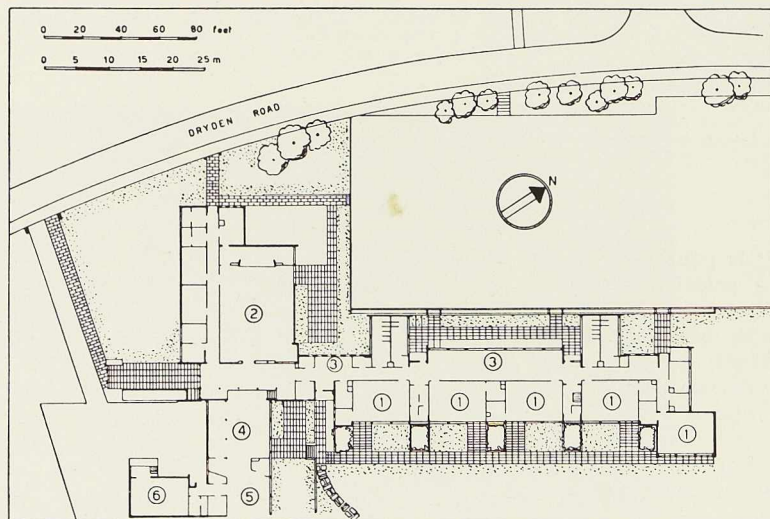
Groupe scolaire d'Ipswich. Plan du rez-de-chaussée de l'école pour « juniors ».
